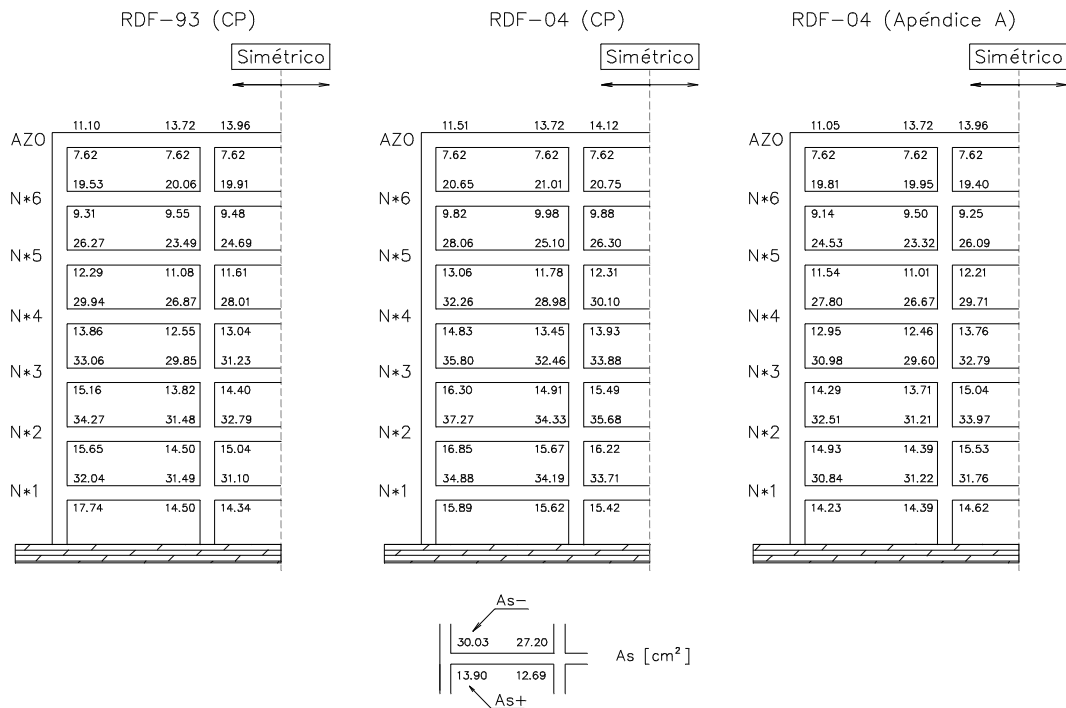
Comparación de áreas de acero de refuerzo longitudinal de las vigas del eje 2 de las estructuras diseñadas en zona III (RDF-93 y RDF-04)
